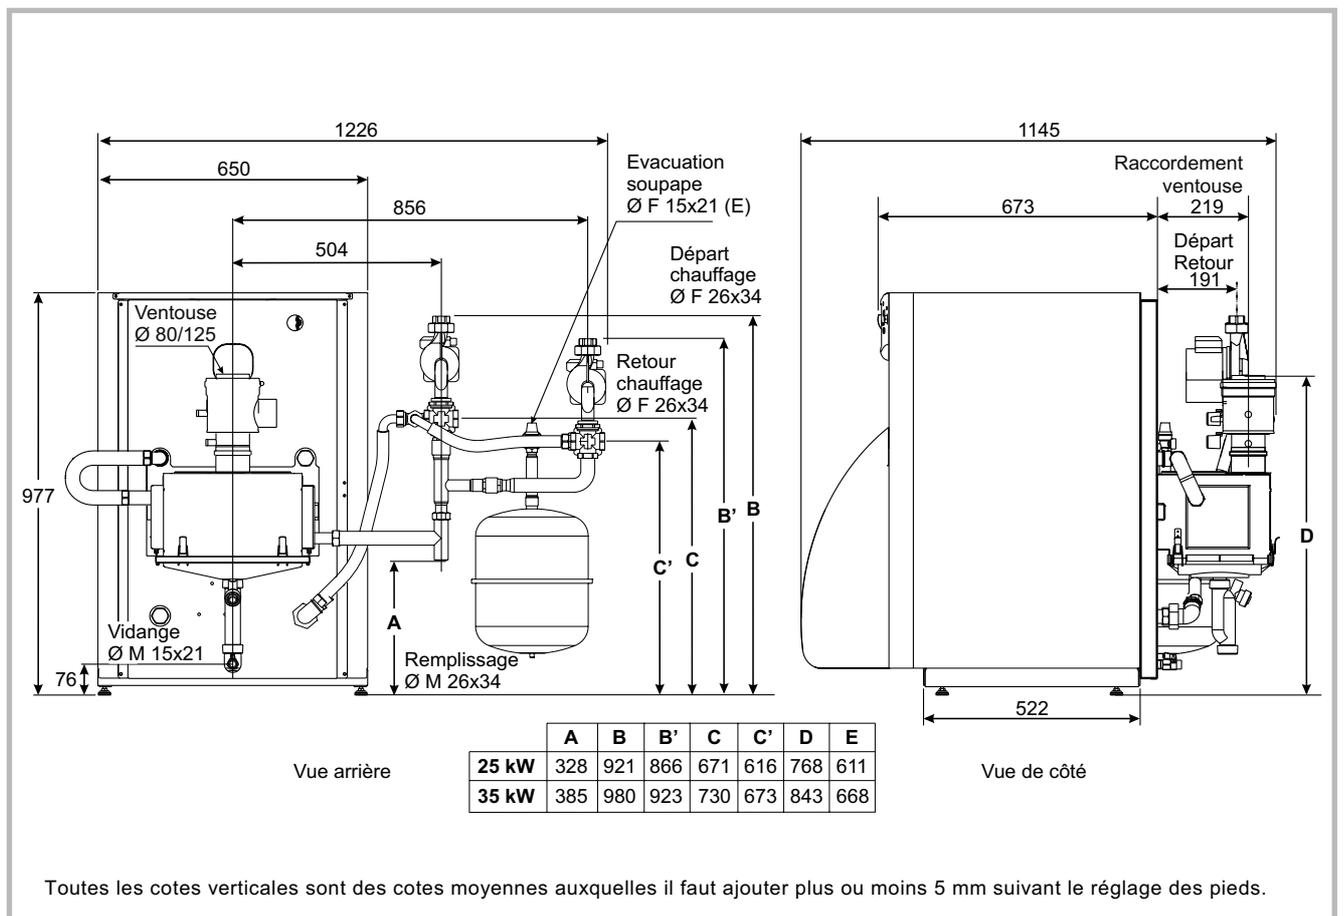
Dimensions en mm (option kit hydraulique 2^{ème} circuit)
